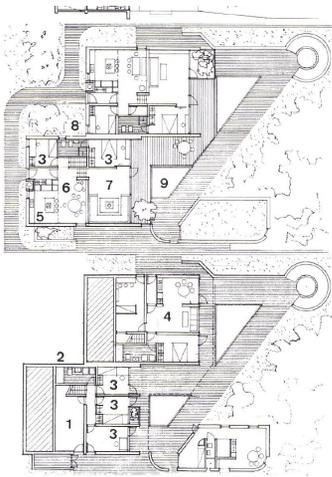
Cohousing, Siedlung Skråplanet, Grundriss
